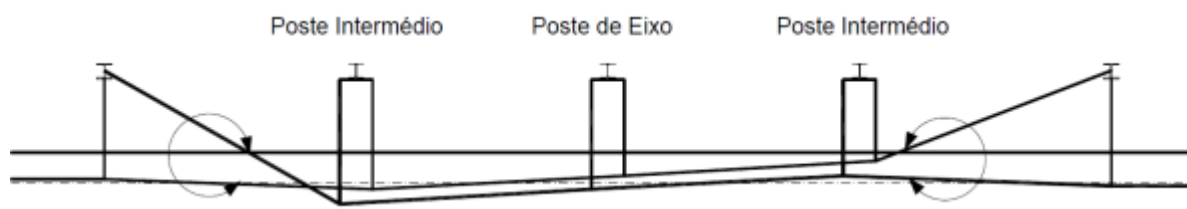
Zona comum e seccionamento de lâmina de ar – representação em planta
